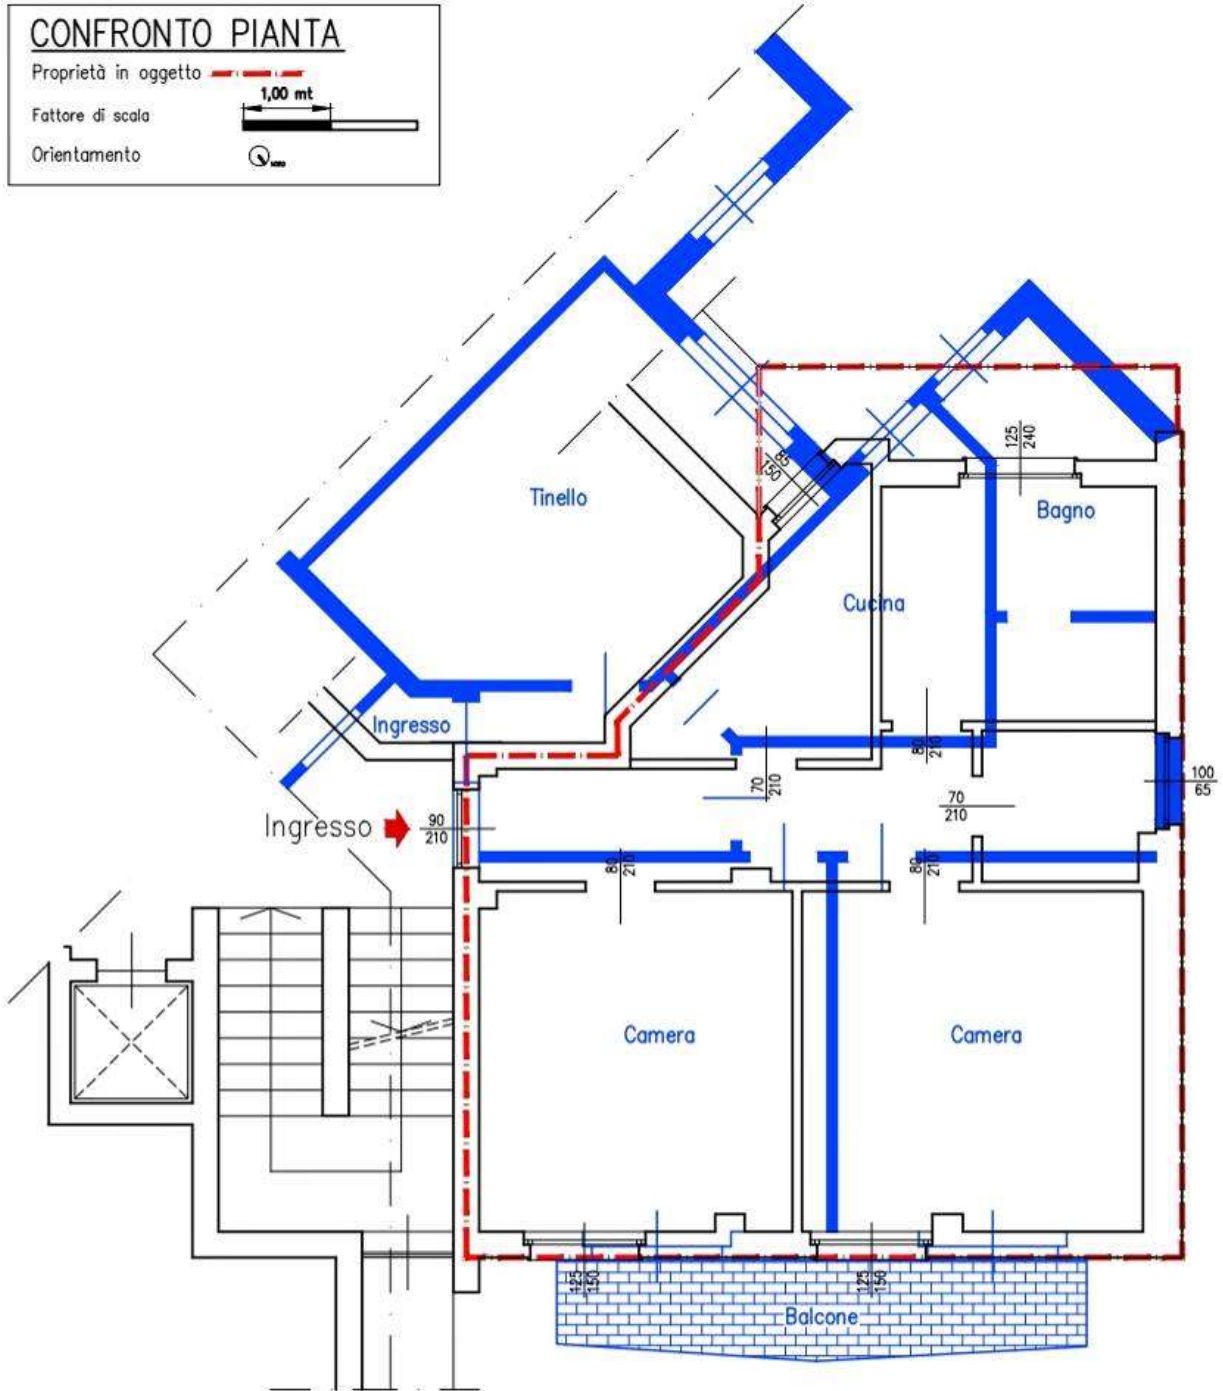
Pianta appartamento al 4° piano: confronto indicativo tra progetto autorizzato (colore blu) e stato dei luoghi.
